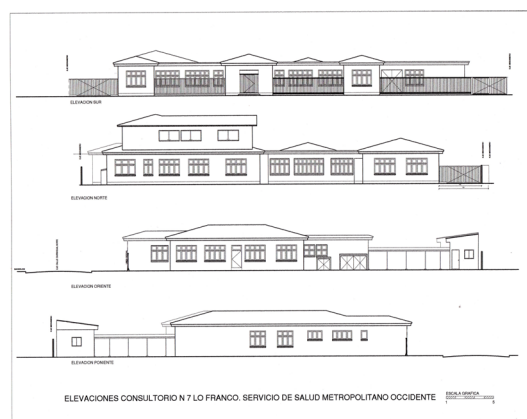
y 32. Planta y elevaciones del CESFAM N°7
